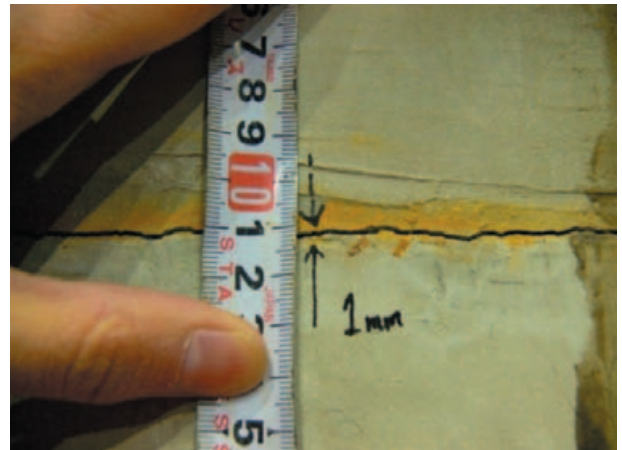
ケース D13-5 実験後の打継ぎ部のひび割れ
